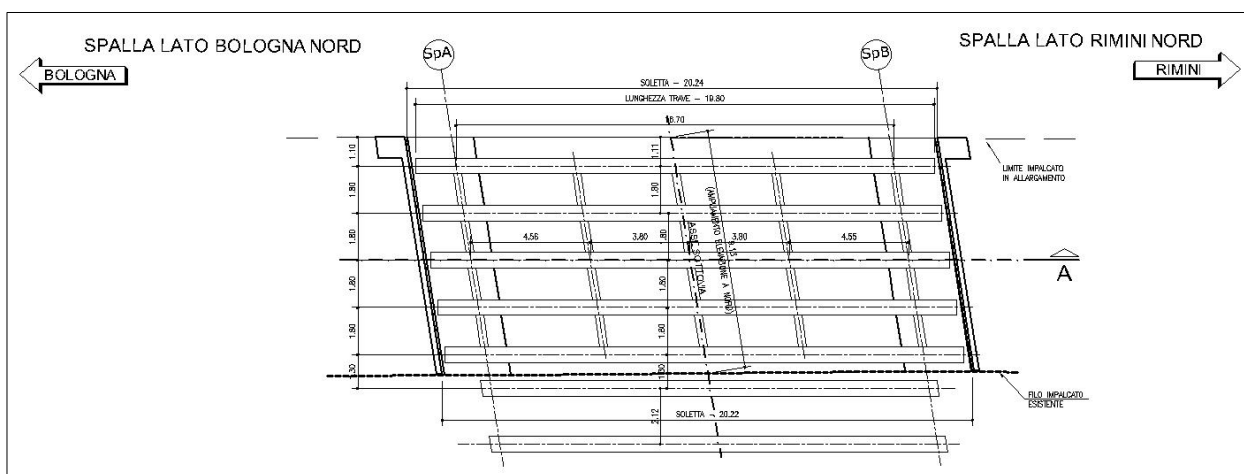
Pianta impalcato ampliamento – Lato Nord
